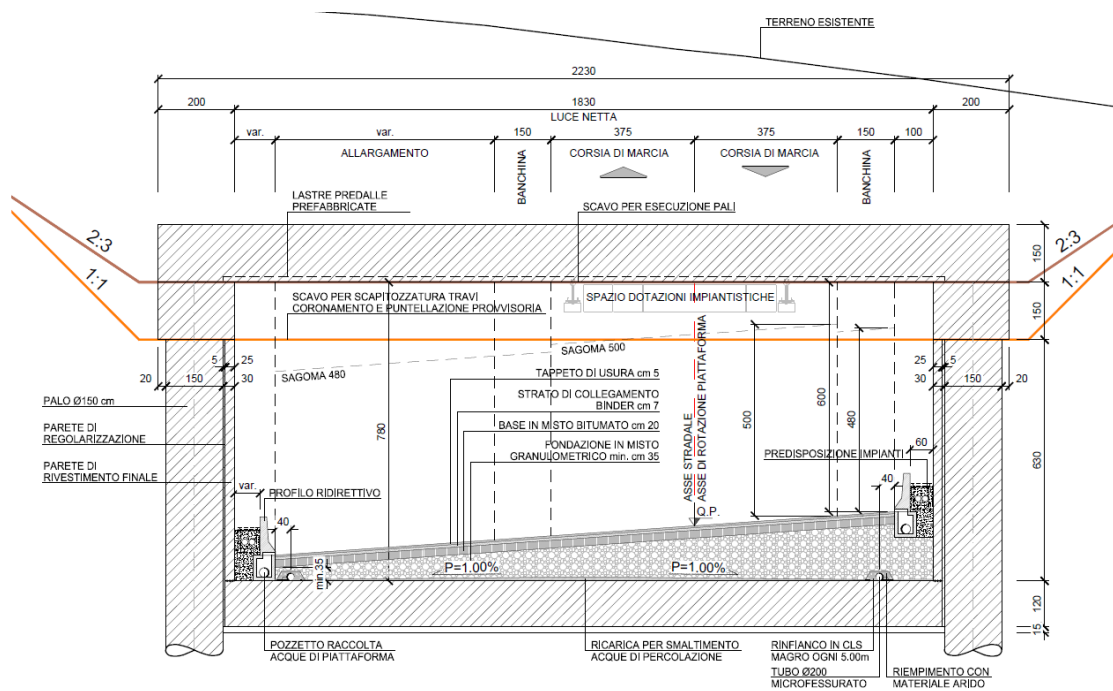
Sezione tipo ad altezza 'convenzionale'
